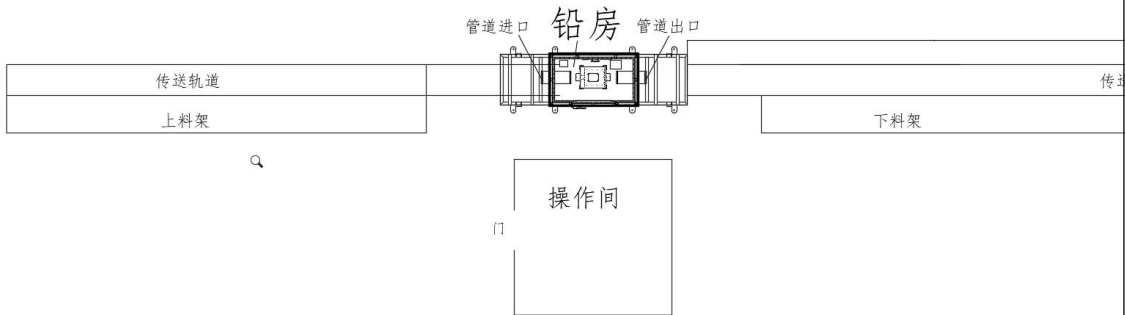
本项目 X 射线数字成像系统项目平面布置图
